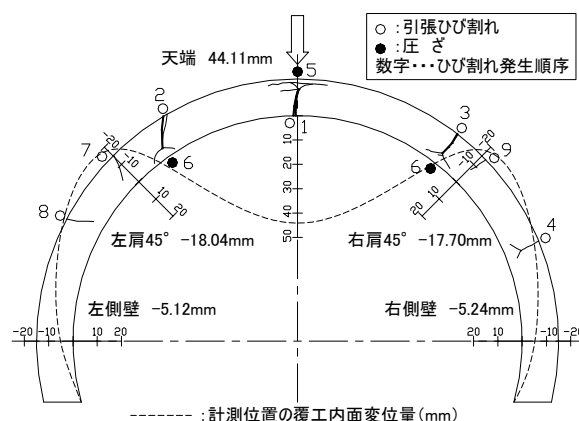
ひび割れ・変形状況（最終押込み時）
